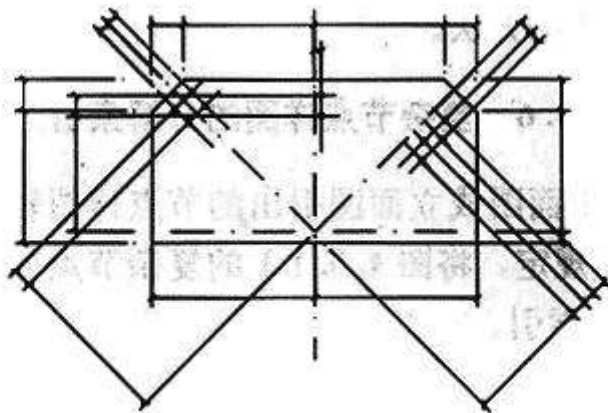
非焊接节点板尺寸的标注方法
